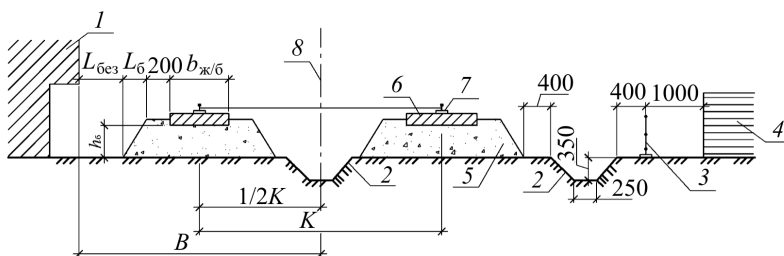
Поперечная привязка башенного крана вблизи здания:
